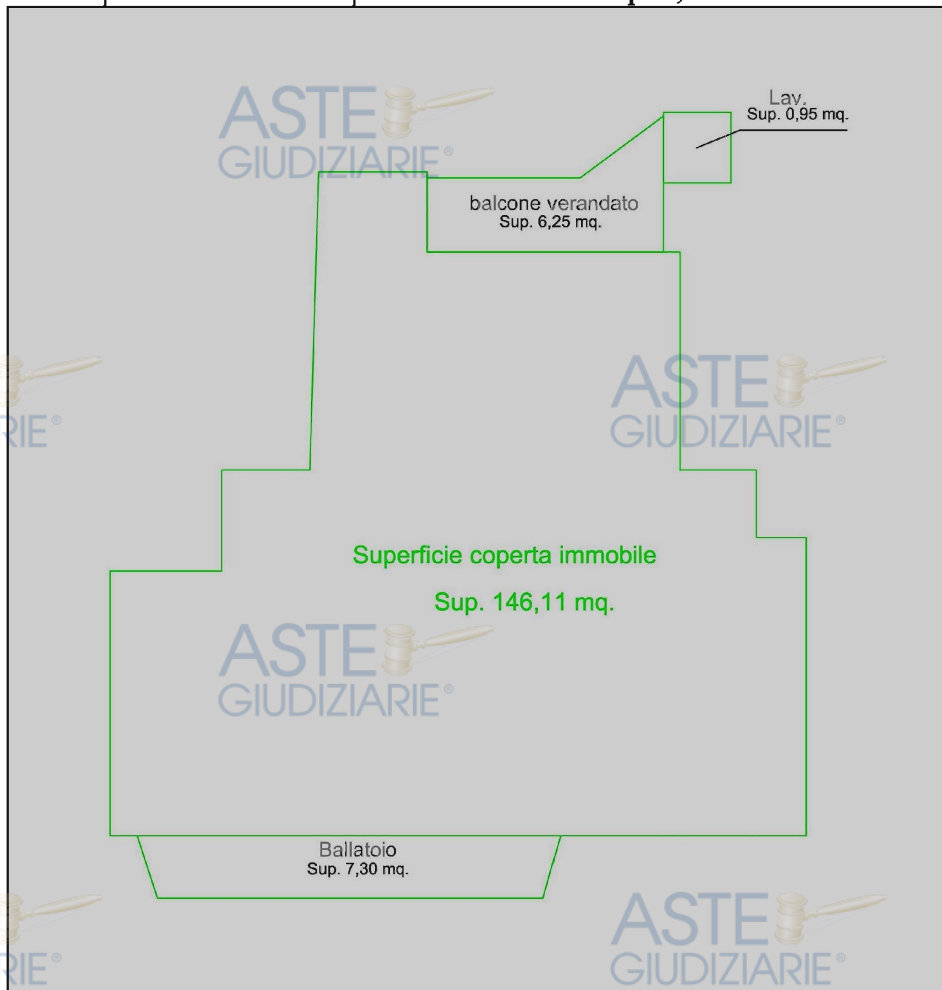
Visualizzazione della planimetria del piano secondo riportante le superfici utili
